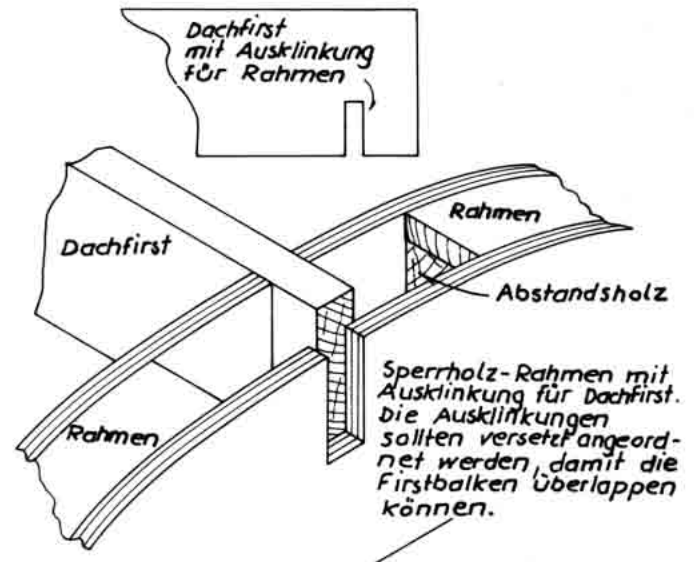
Firstkonstruktion eines Bauschuppens.
